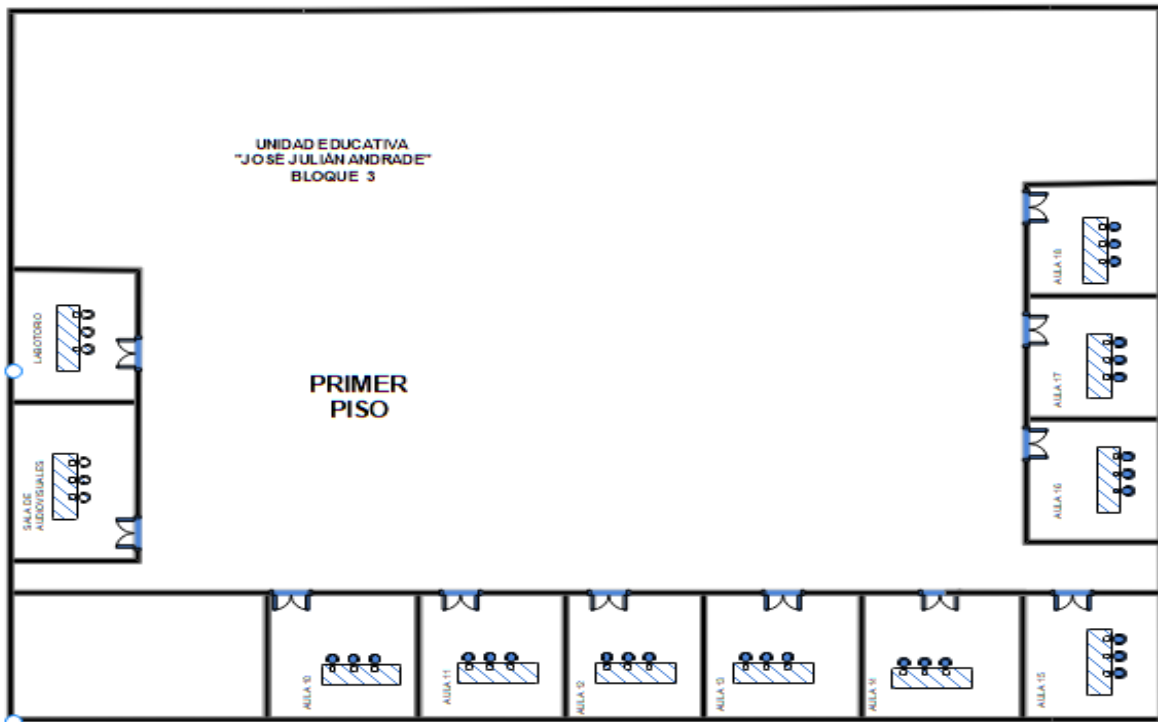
Plano de la estructura del bloque 3, primer piso de la institución
